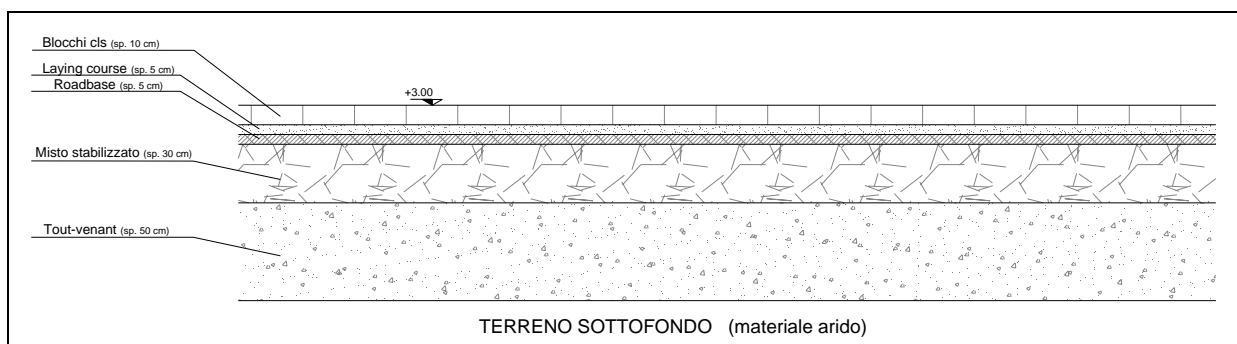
Schema pavimentazione flessibile con blocchi in calcestruzzo
